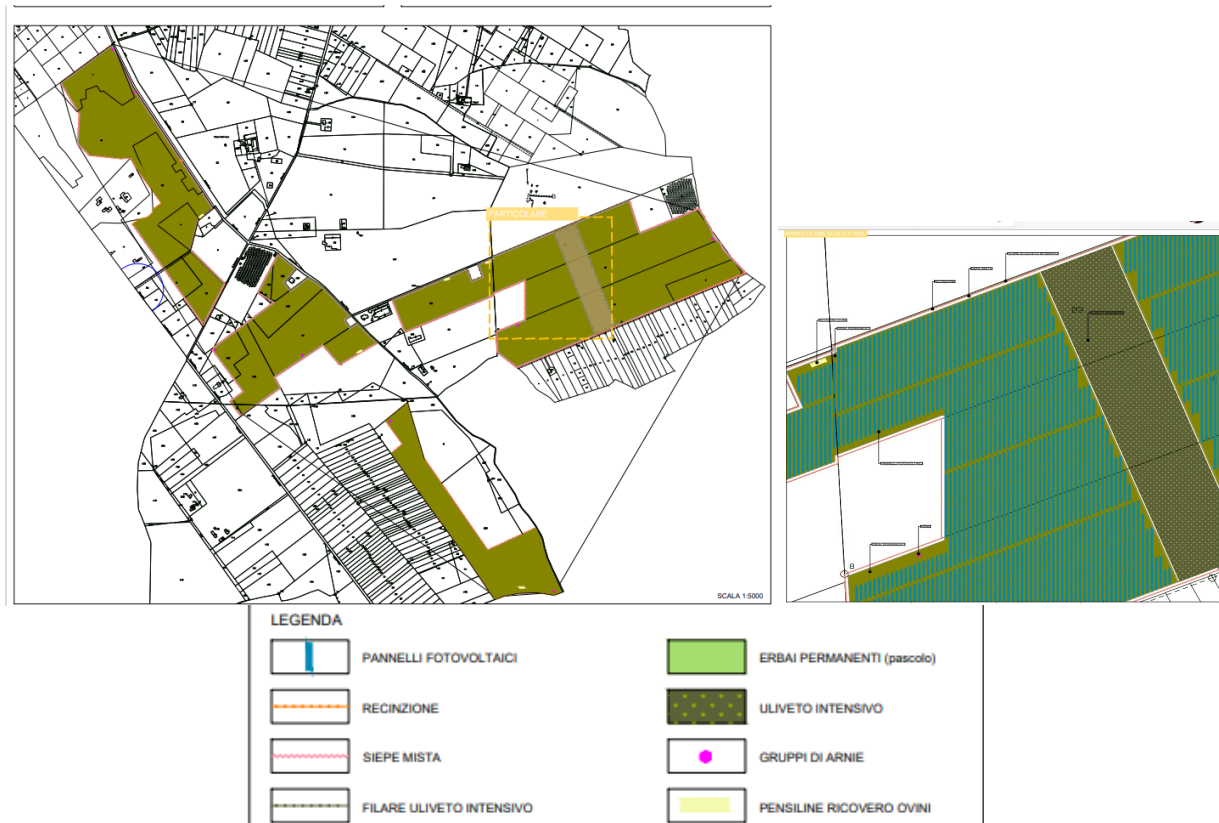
planimetria del progetto agricolo (EP_09_2)
